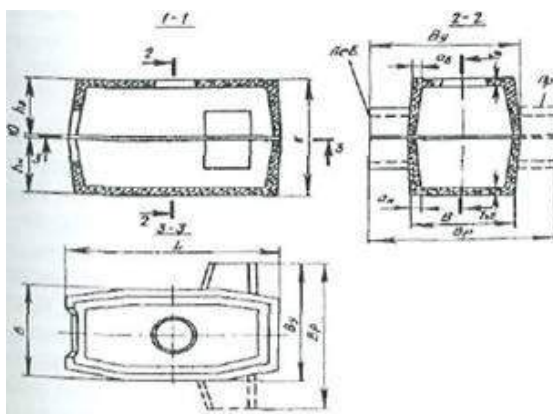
Сборные железобетонные колодцы угловые типа ККСу-3, ККСу-4 и ККСу-5
